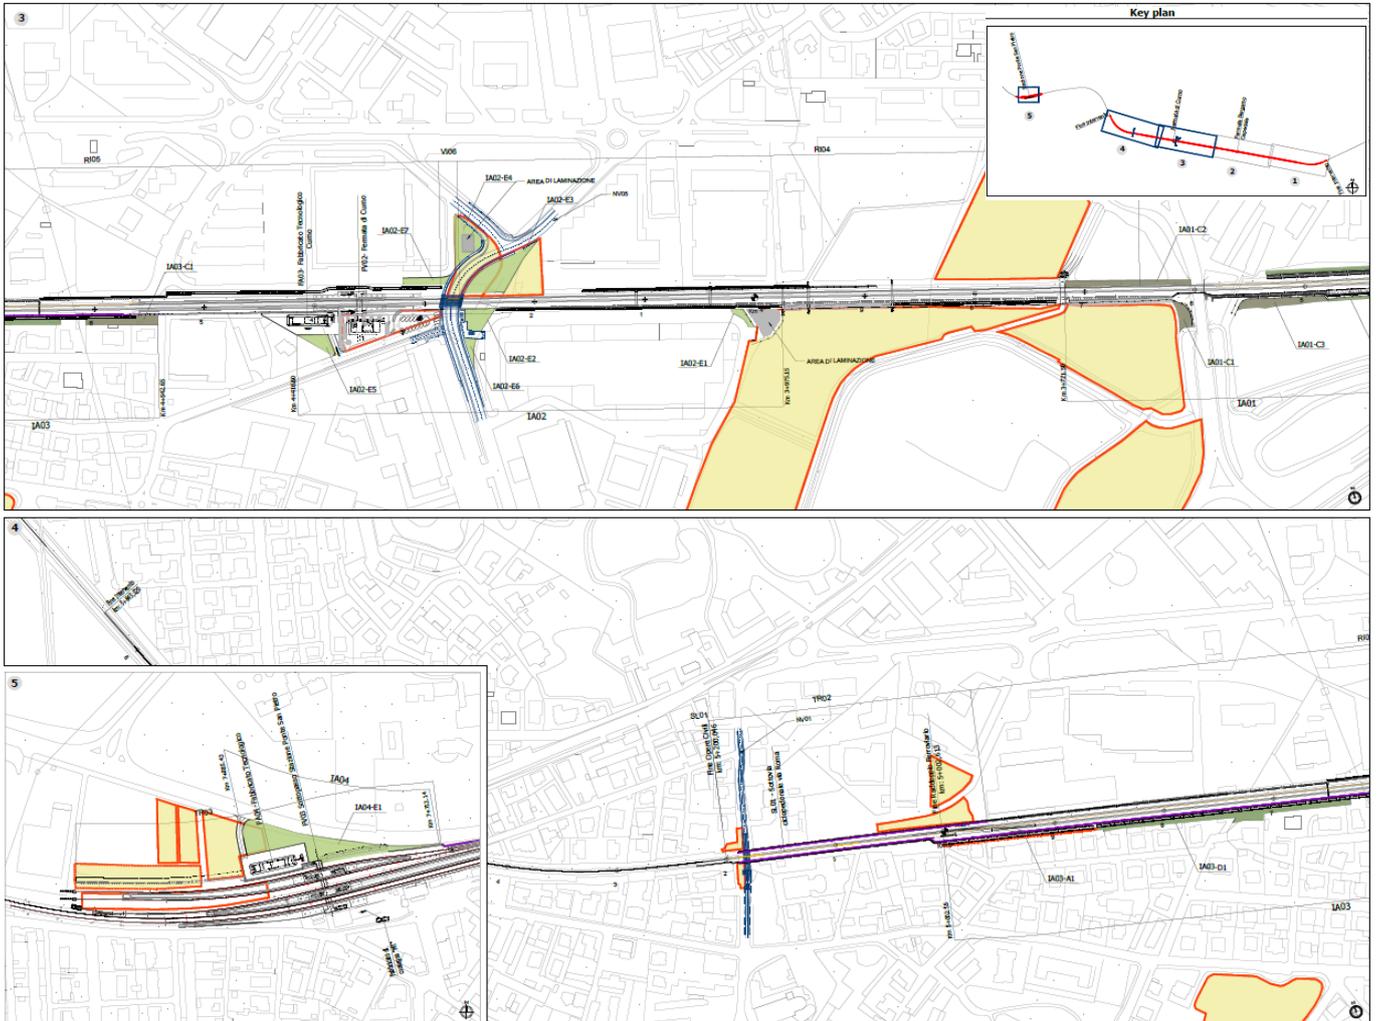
Stralcio planimetria generale degli interventi a verde per il 2° appalto
